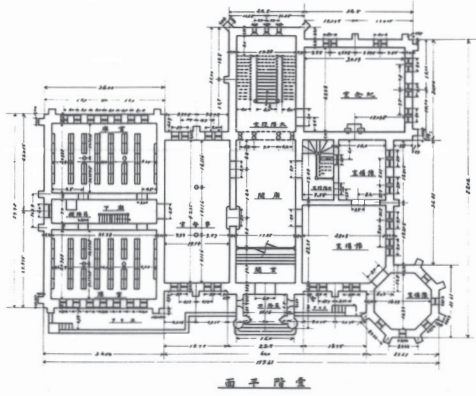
各階平面図 当初設計図『第壹號』・『第貳號』
